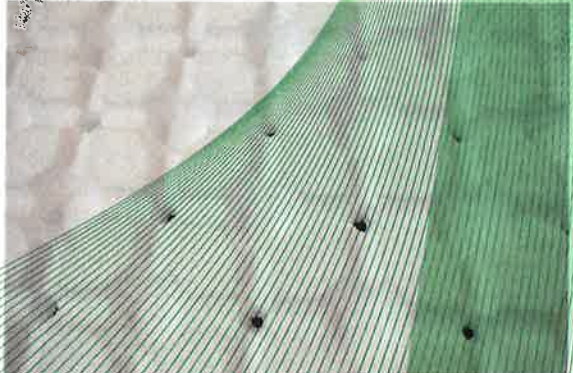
Anschlagereinrichtung, Typ: Fallnet® SR mit Rasterelementen
